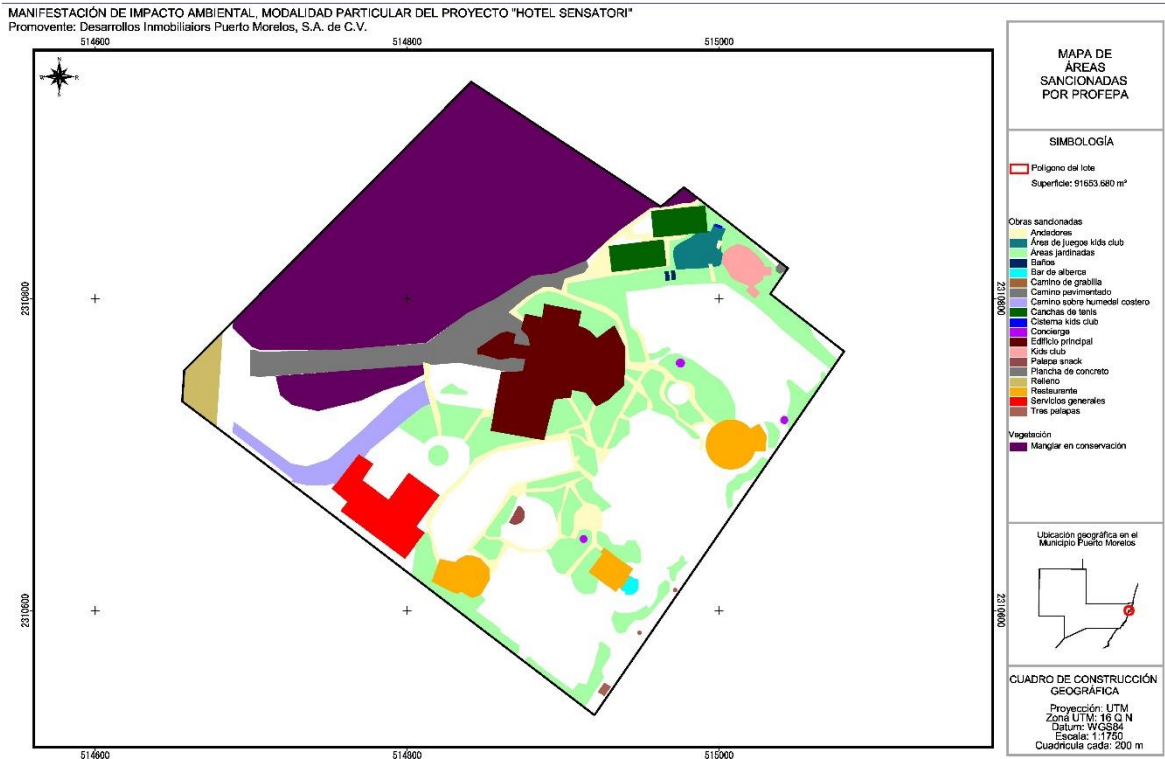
Plano de conjunto de obras sancionadas del proyecto "Hotel Sensori"
